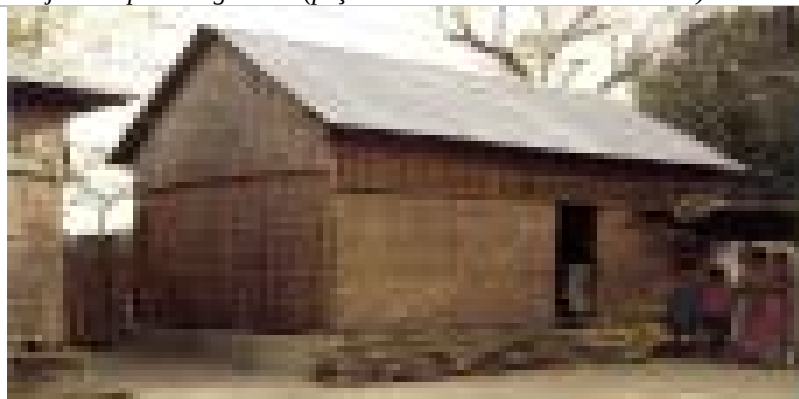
Construção Turcas: Bangladesh (fot. Banco Gramenne)
